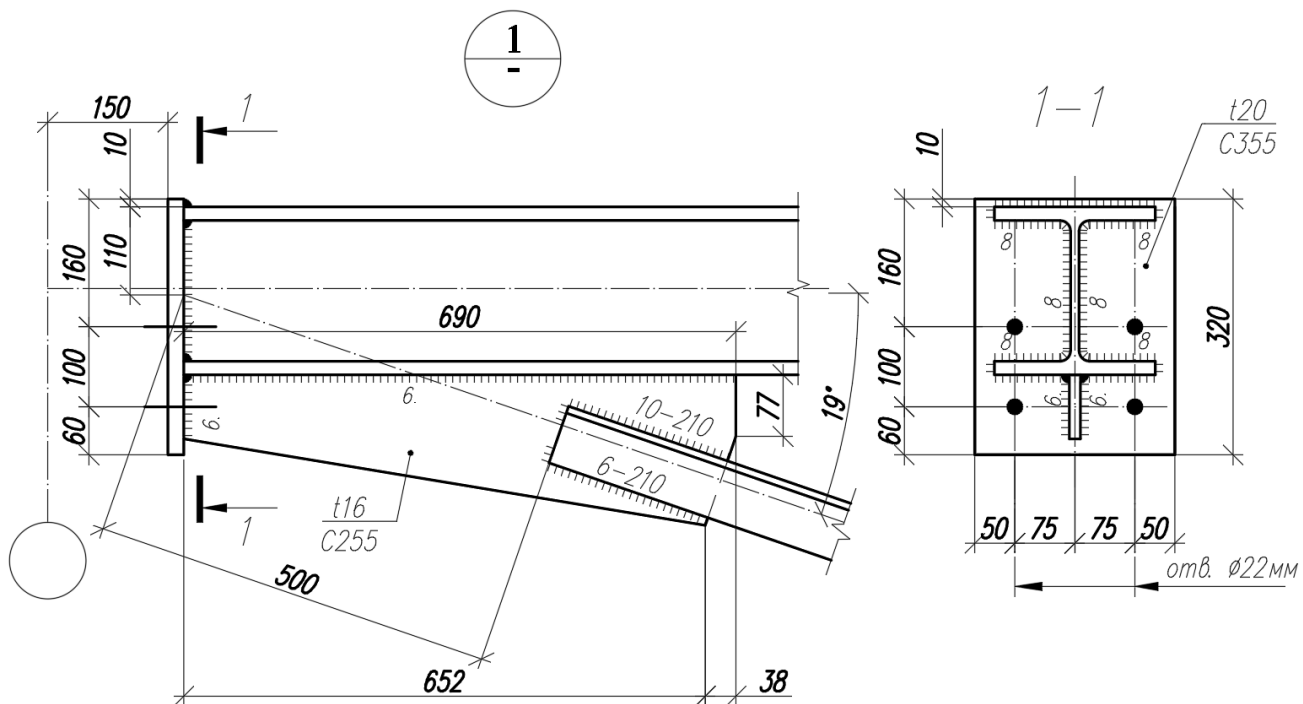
Узел 1 подстропильной фермы ФП-12-55.
